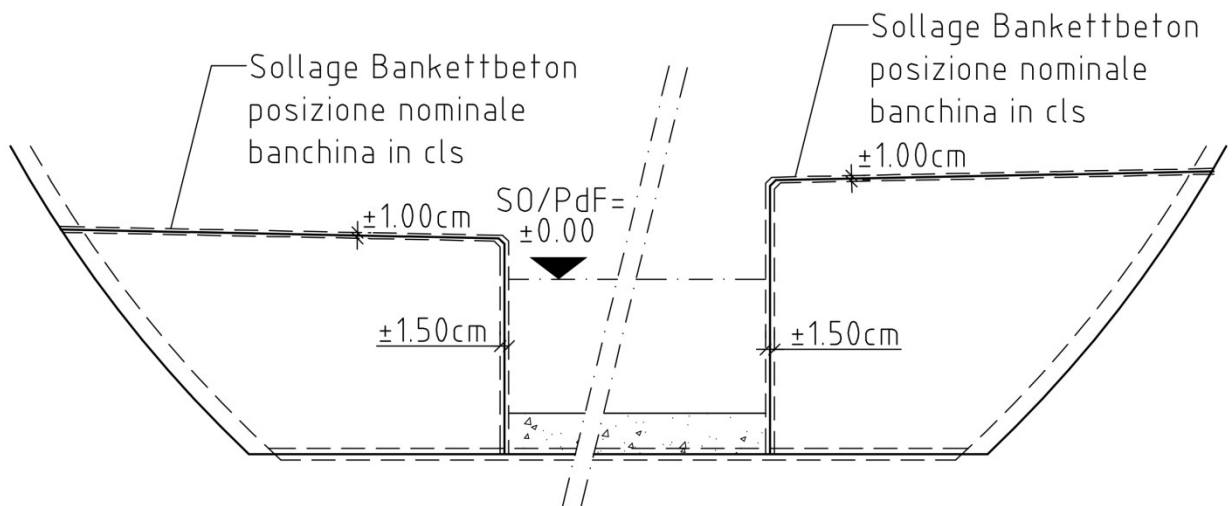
Toleranzen Haupttunnel - Bankett (Betonbankett)
